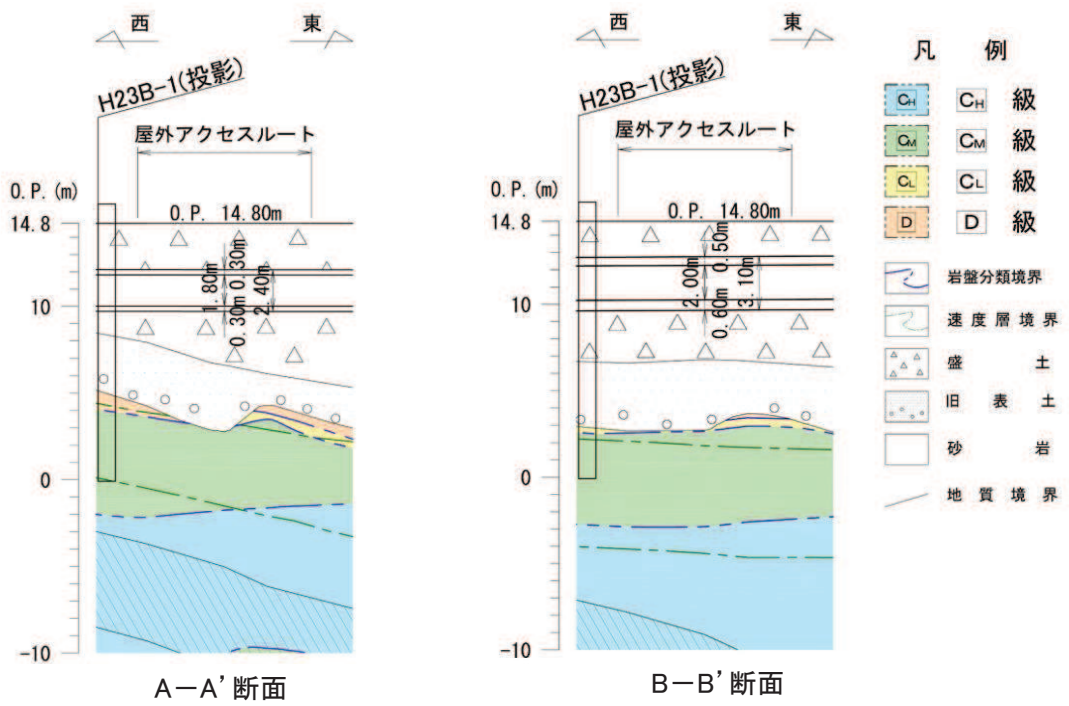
地質断面図 (A-A' 断面, B-B' 断面)
